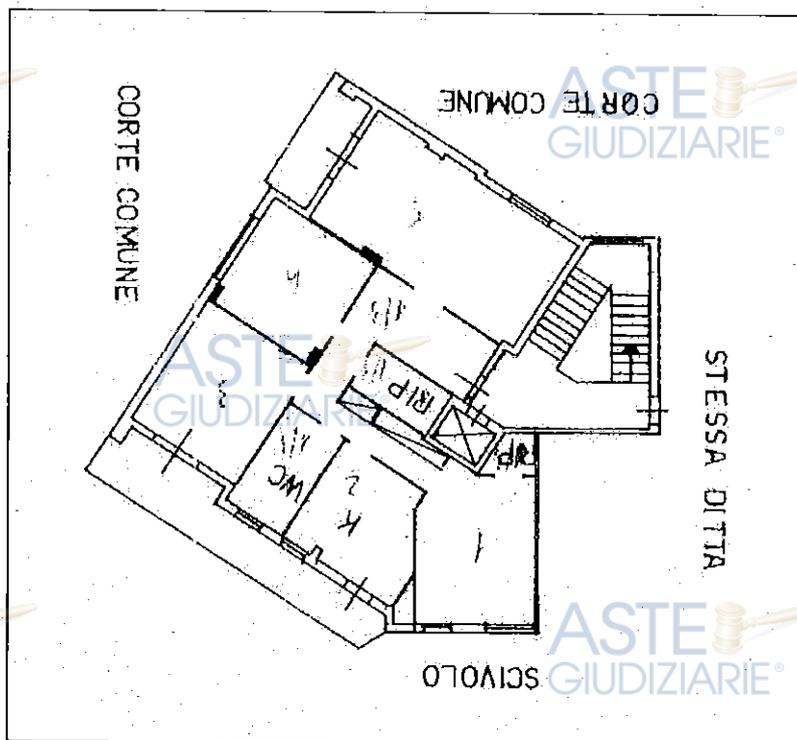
Estratto della planimetria catastale depositata il 13/12/1986.
